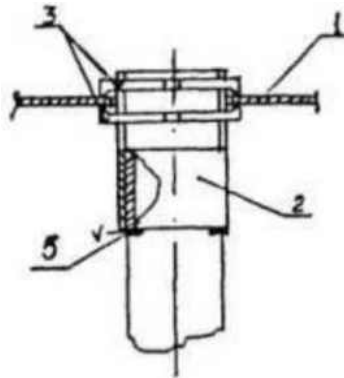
Ввод в оболочки и аппараты труб без резьбы: 1 - корпус аппарата, 2 - патрубок вводной, 3 - гайка заземляющая, 5 - сварка.
